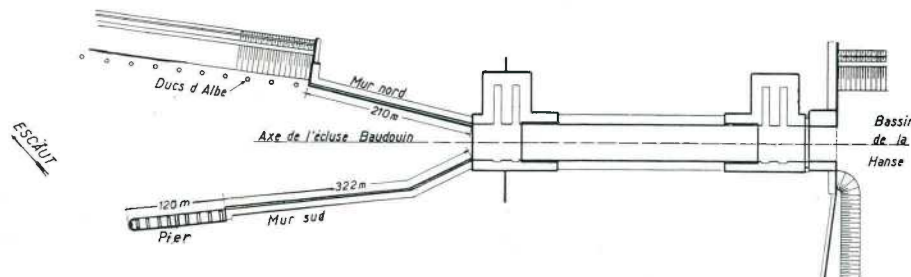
PLAN SCHÉMATIQUE MONTRANT LA DISPOSITION DES RIDEAUX DE PALPLANCHES.
